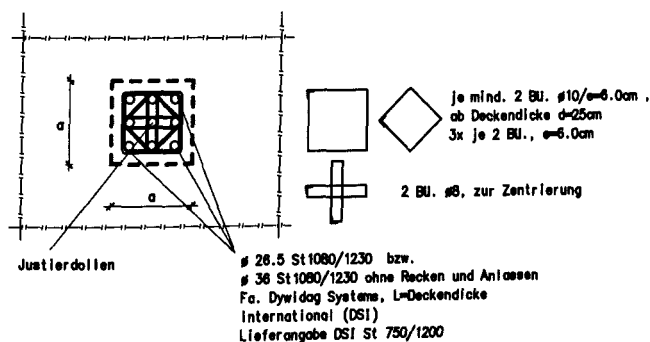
Bewehrungselement im Grundriss und Schnitt
